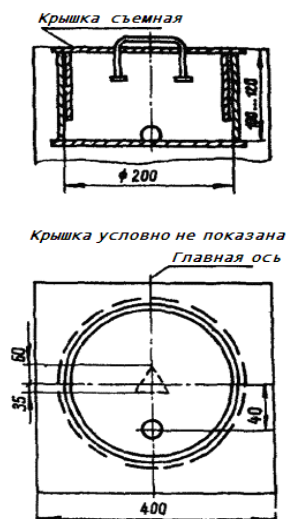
Плашки с репером, вынесенные на отдельный фундамент
